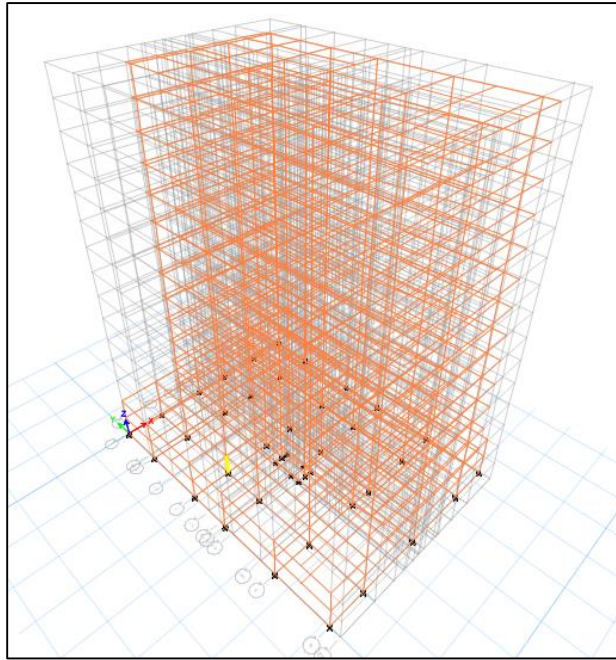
Columna B3 tipo 4 de 60x40cm Story 1
